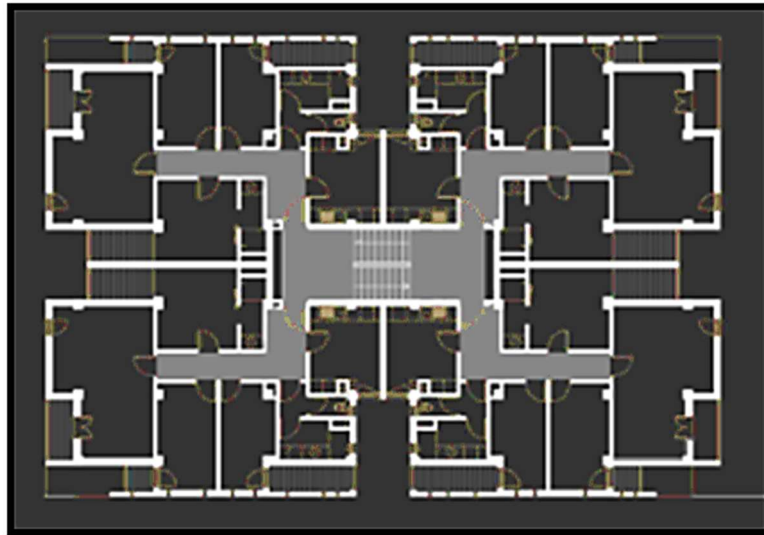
Le plan de bâtiment A de la résidence tirsanine.
